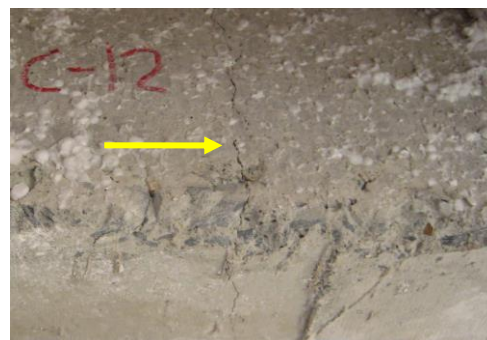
Fisuración en viga por flexión y/o deformación excesiva
